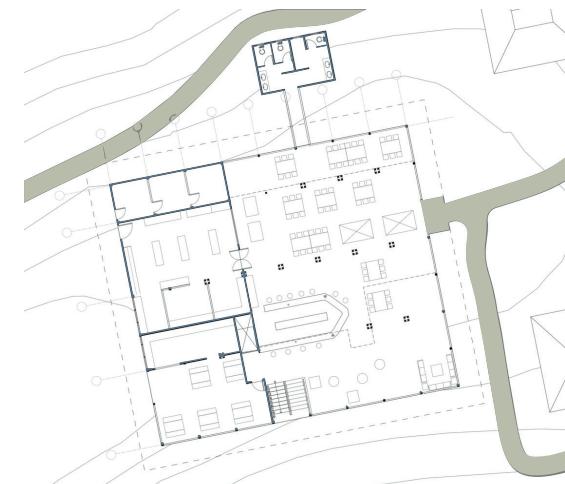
Planta Arquitectónica Torre Napo Wildlife Center
